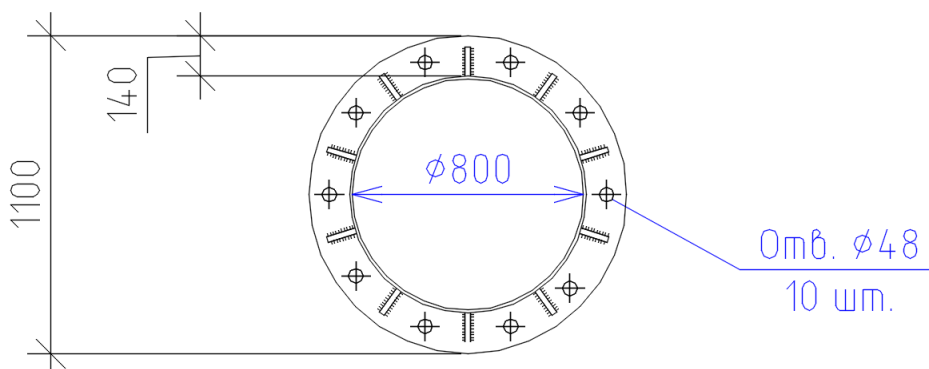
Фланец для соединения элементов верхнего пояса фермы
